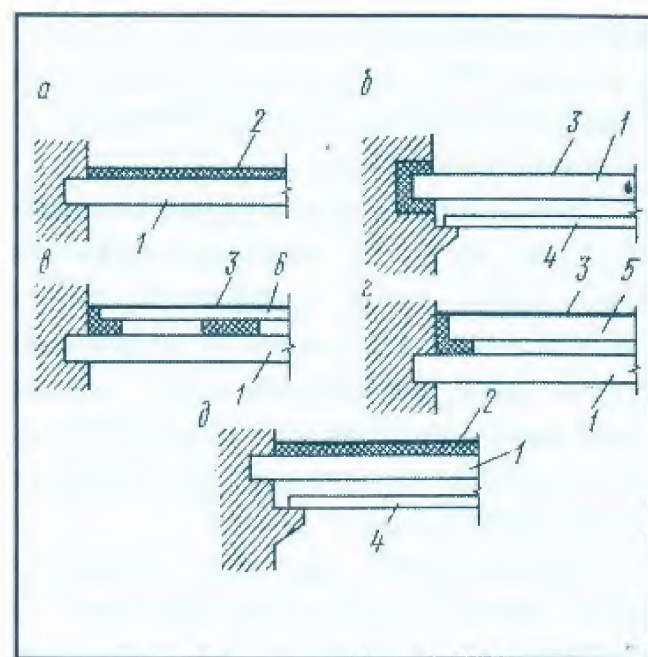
Конструктивні схеми залізобетонних міжповерхових панельних перекриттів: а - з шаруватим перекриттям підлоги; б - з роздільною стелею; в - з роздільною підлогою; г - з двох несучих панелей; д - з шаруватим покриттям підлоги і роздільною стелею; 1 - несуча панель перекриття; 2 - звукоізолююча шарувата підлога; 3 - покриття підлоги; 4 - панель роздільної стелі; 5 - несуча панель підлоги; 6 - панель роздільної підлоги.
